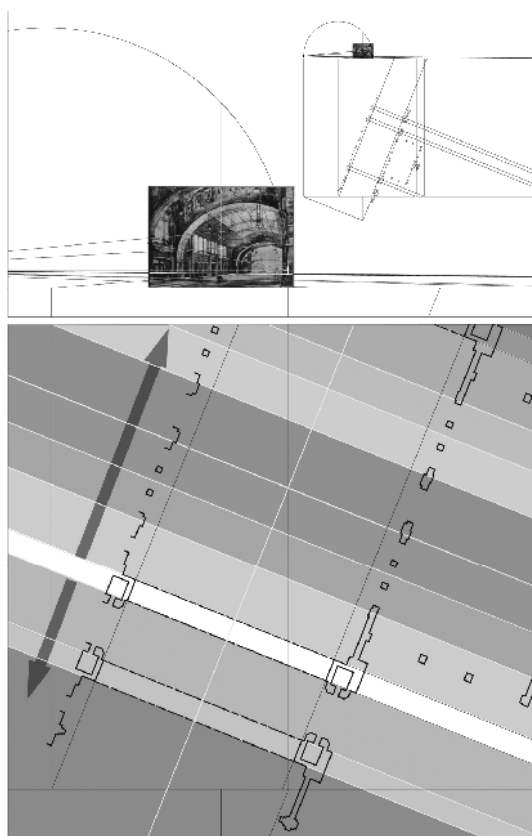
Individuazione dei piani di profondità mediante ricostruzione geometrica in prospettiva inversa. La sezione di pianta in bianco costituisce il principale piano di fuoco.
